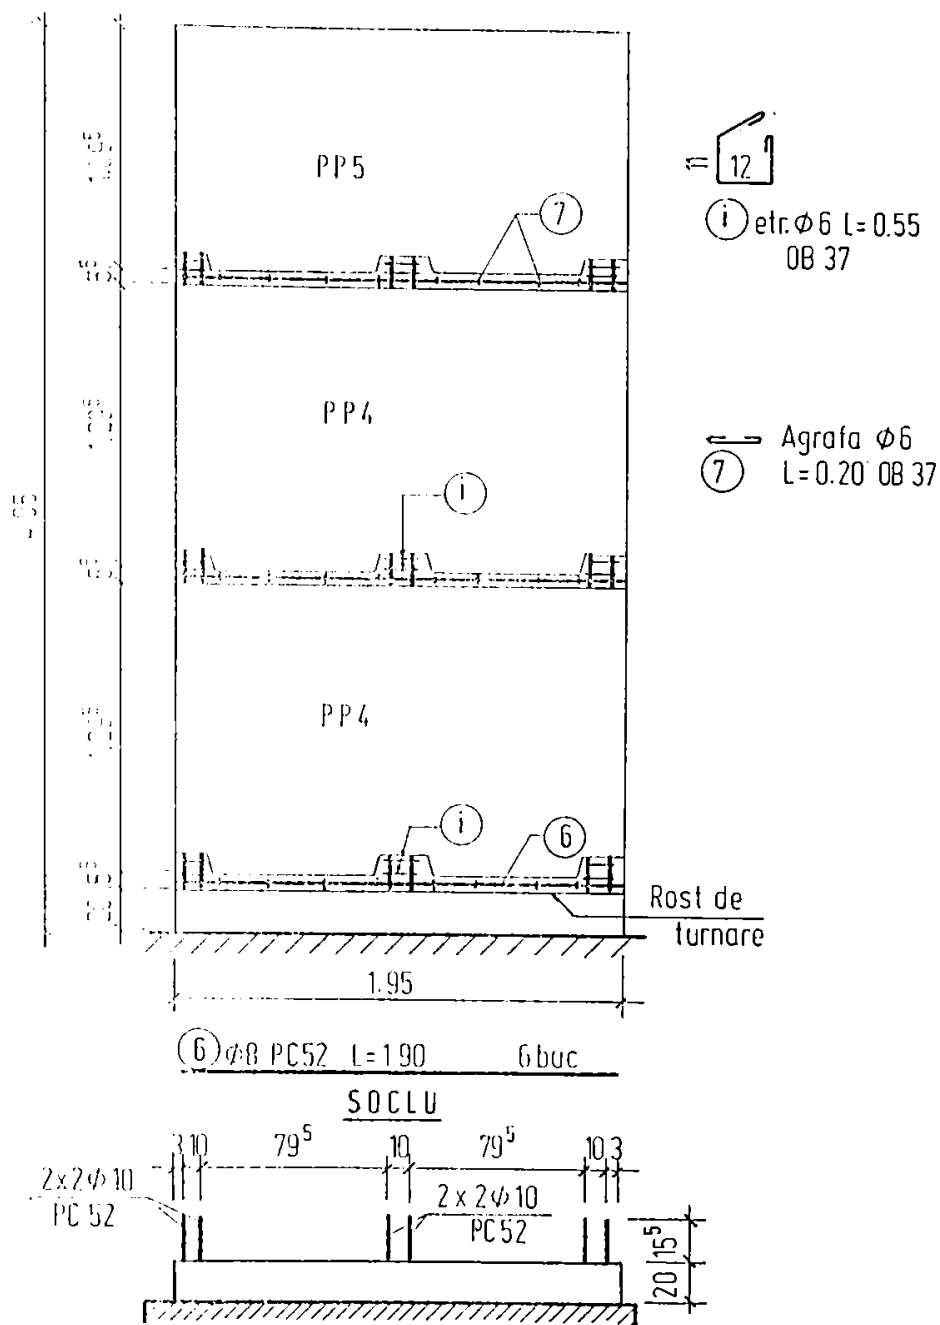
PERETE STRUCTURAL PREFABRICAT - MODEL F4 - ARMARE MONOLITIZĂRI
